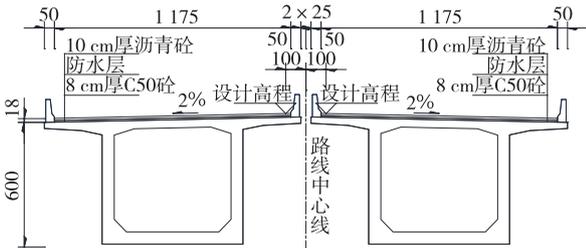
预应力砼桥梁标准横断面示意图(单位:cm)
